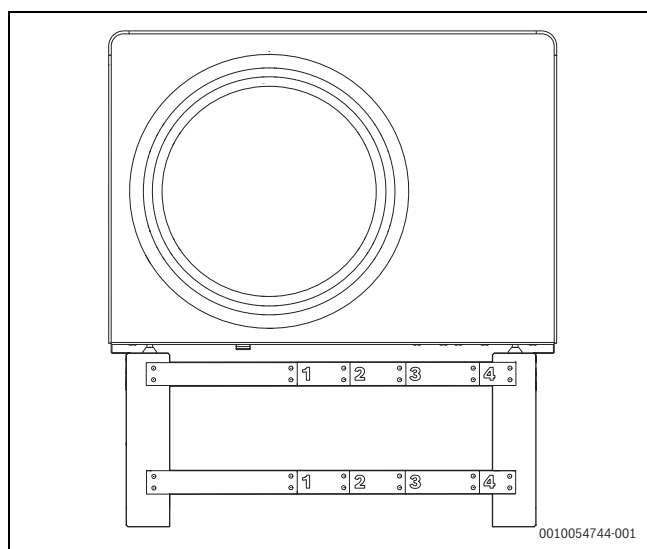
Príklad montáže: prefabrikovaný základ v zemi
